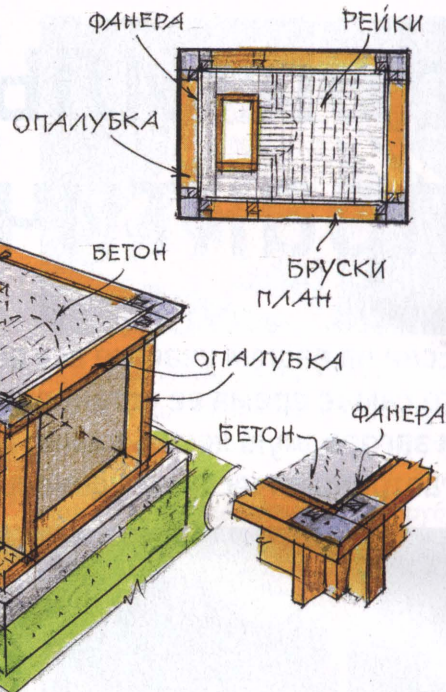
Конструкция опалубки для отливки бетонного тулова универсальной садовой печи.
